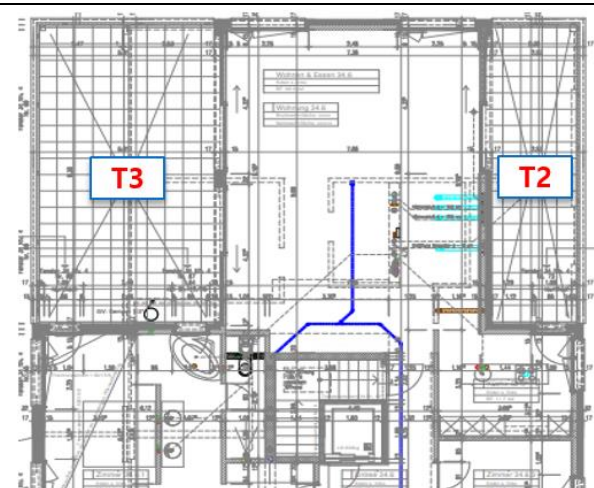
Haus 34 Dachgeschoss | Übersicht
